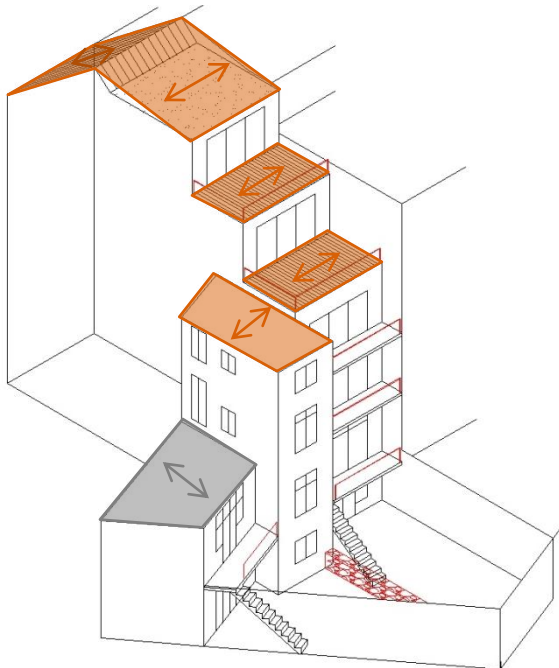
Sens de portée des poutres FJI et des gîtes en toiture (Source : Draps E., 2010)
